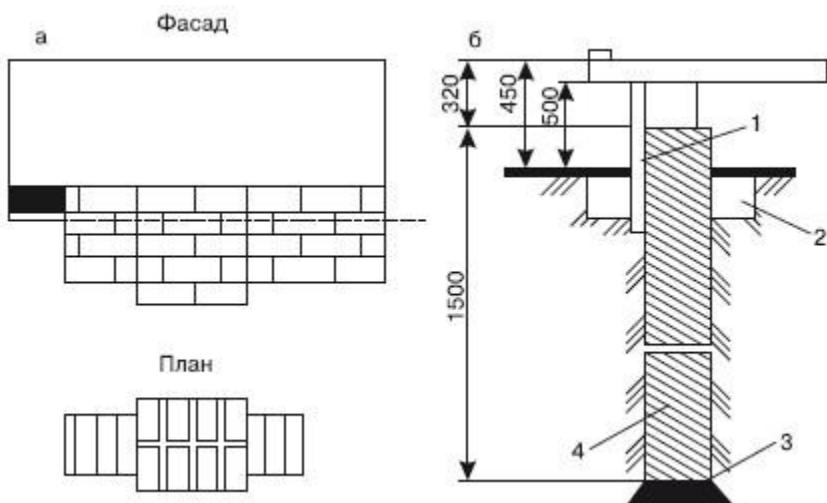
Столбчатые фундаменты для бани: а – со столбами из кирпича; б – со сваями из асбестоцементной трубы: 1 – асбестоцементный лист; 2 – бетон; 3 – подшивка фундамента; 4 – асбестоцементная труба, заполненная бетоном
